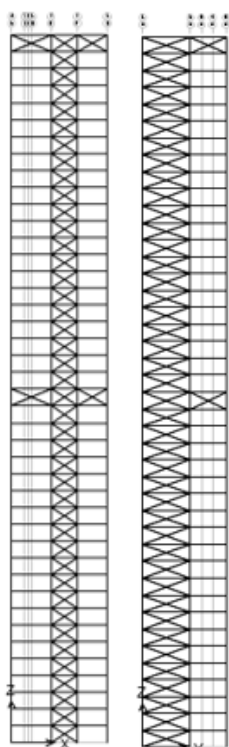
Elevações do modelo com treliças verticais e duas cintas horizontais
